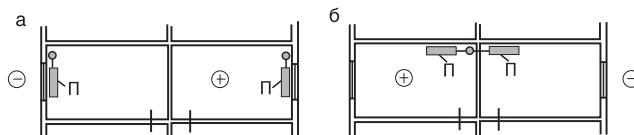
Размещение отопительных приборов (П) в плане: а – под окнами; б – у внутренних стен
